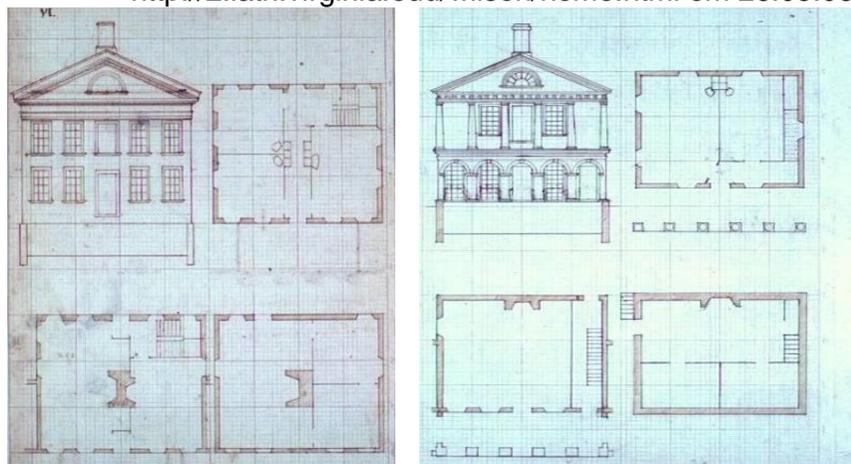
Pavilhão 7; Fig.: 96 - Pavilhão 8
